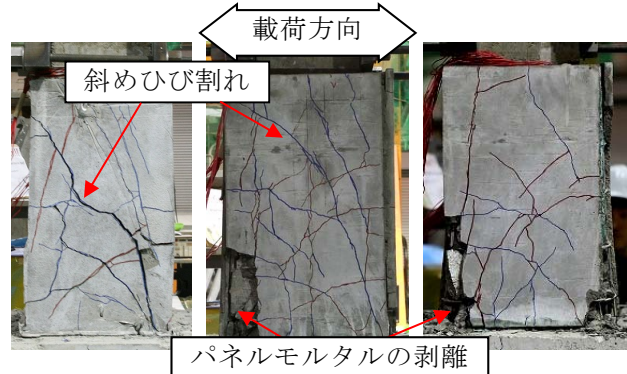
終局変位直前荷重サイクル終了時のひび割れ性状
